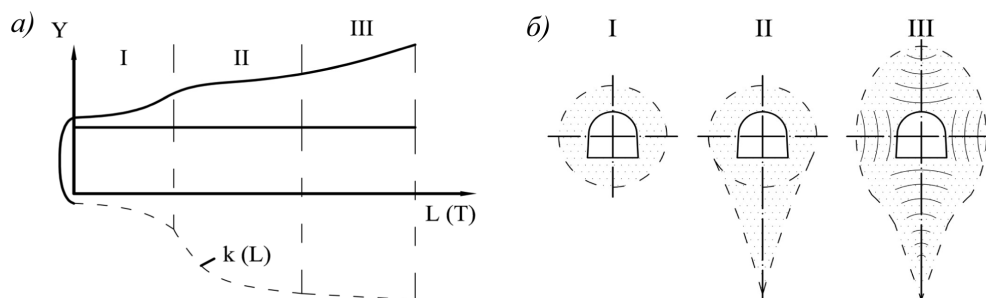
Развитие геомеханических процессов по мере перемещения забоя выработки: продольный (а) и поперечный (б) разрезы
